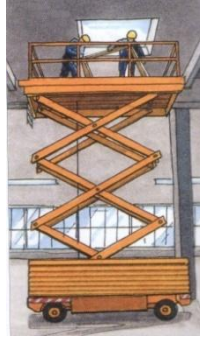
Plataforma elevadora autopropulsada tipo tijera
